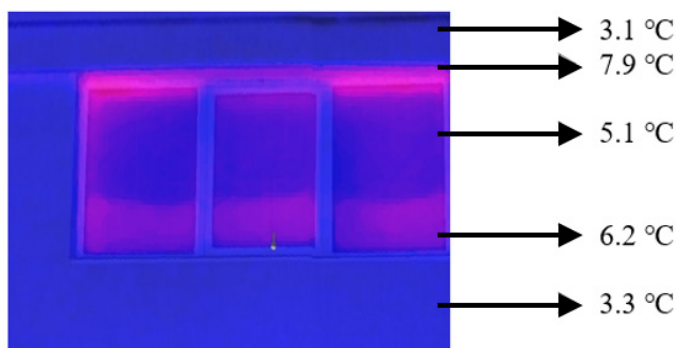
Exemple ale pierderilor de căldură când geamurile sunt închise
